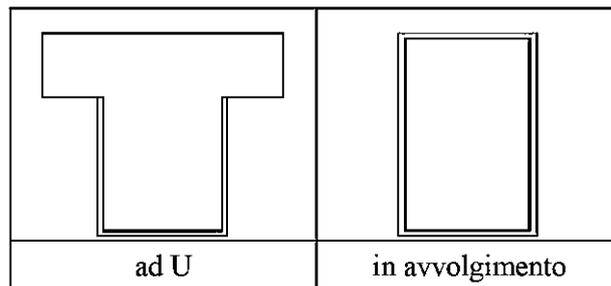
Disposizione fibre trave (Fonte: CNR DT 200 R1/2013)
